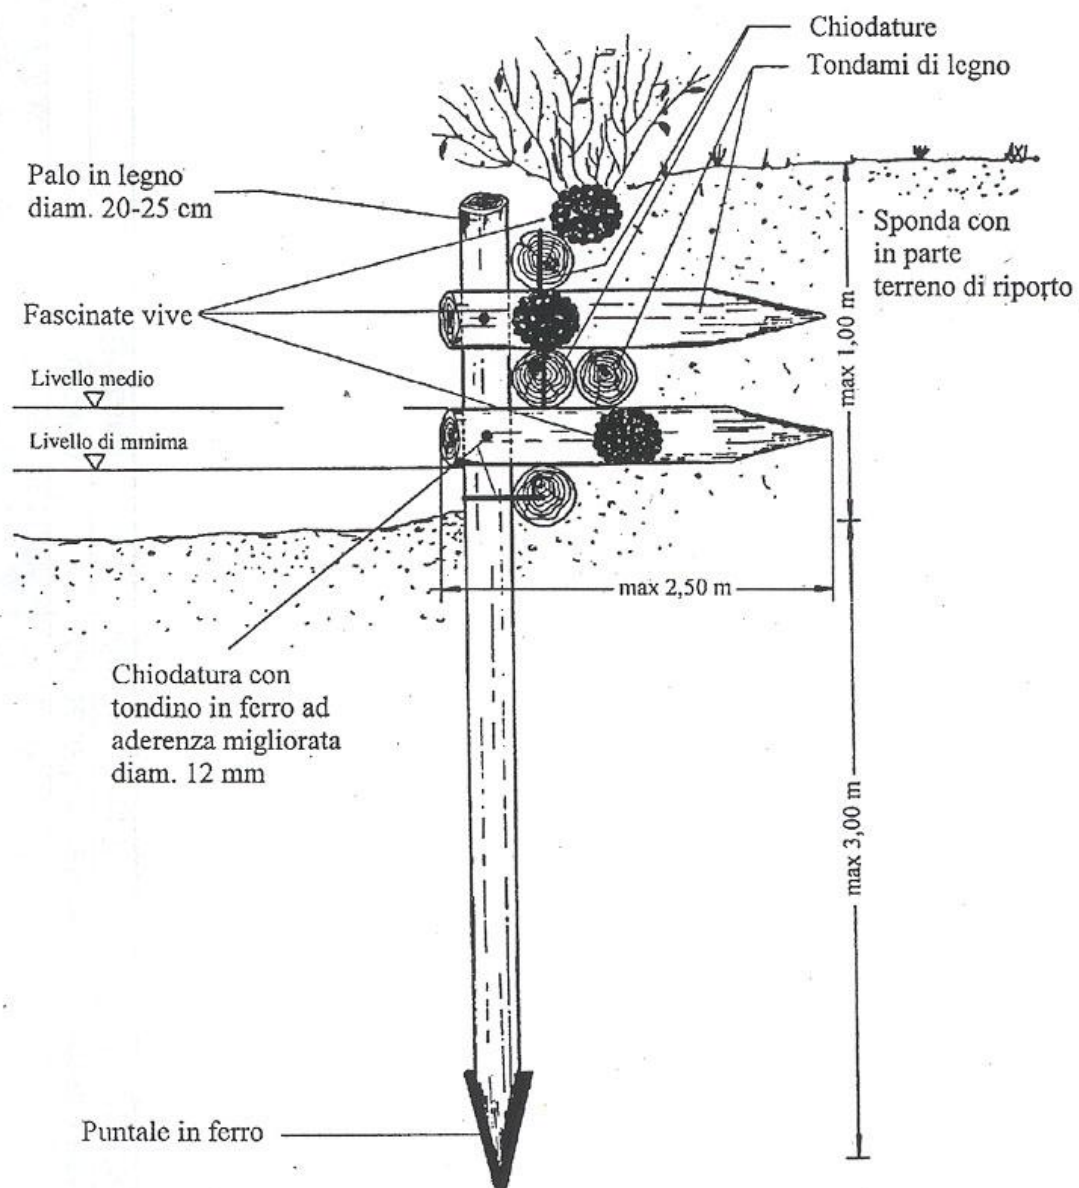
Palificata spondale con palo verticale frontale - sezione.
